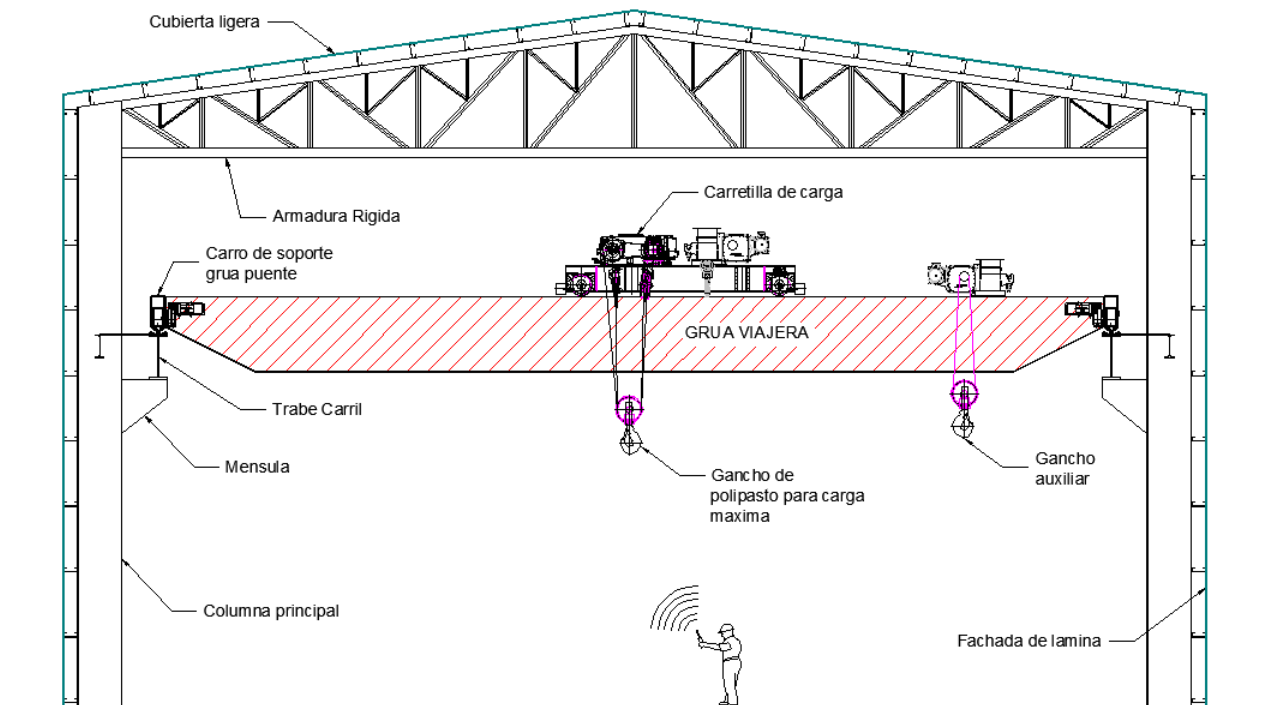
Estructura principal a base de columnas en de concreto o acero con apoyo de ménsula para trabe carril y armadura rígida a dos aguas para la cubierta.
